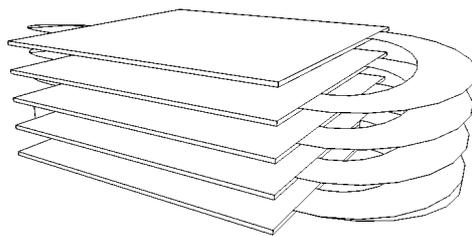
Rampas helicoidais (adaptado de Klose, Drietrich – Parkhauser und Tiefgarage)
